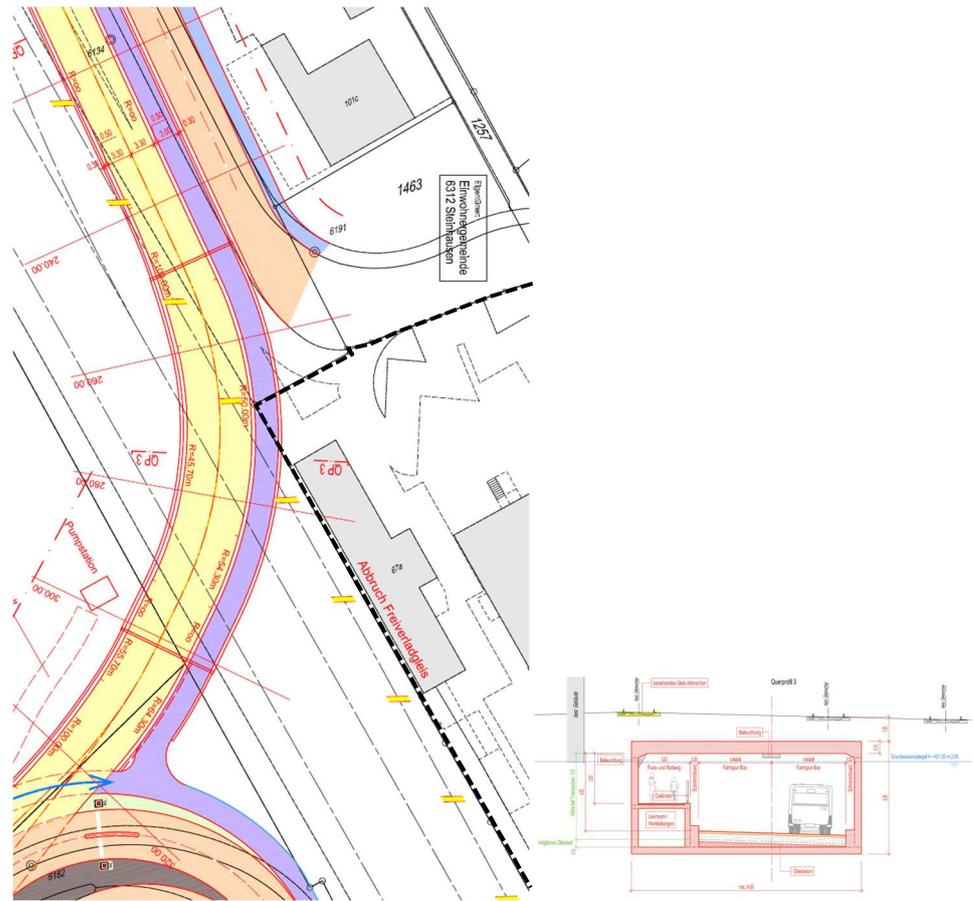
Raumbefreiung ÖV-Finverteiler: Situation (links, Studienauftragsperimeter gestrichelt eingetragen) und Querprofil 3 (rechts), Vorabzug, Berthold+Eicher AG, 20.12.2007
